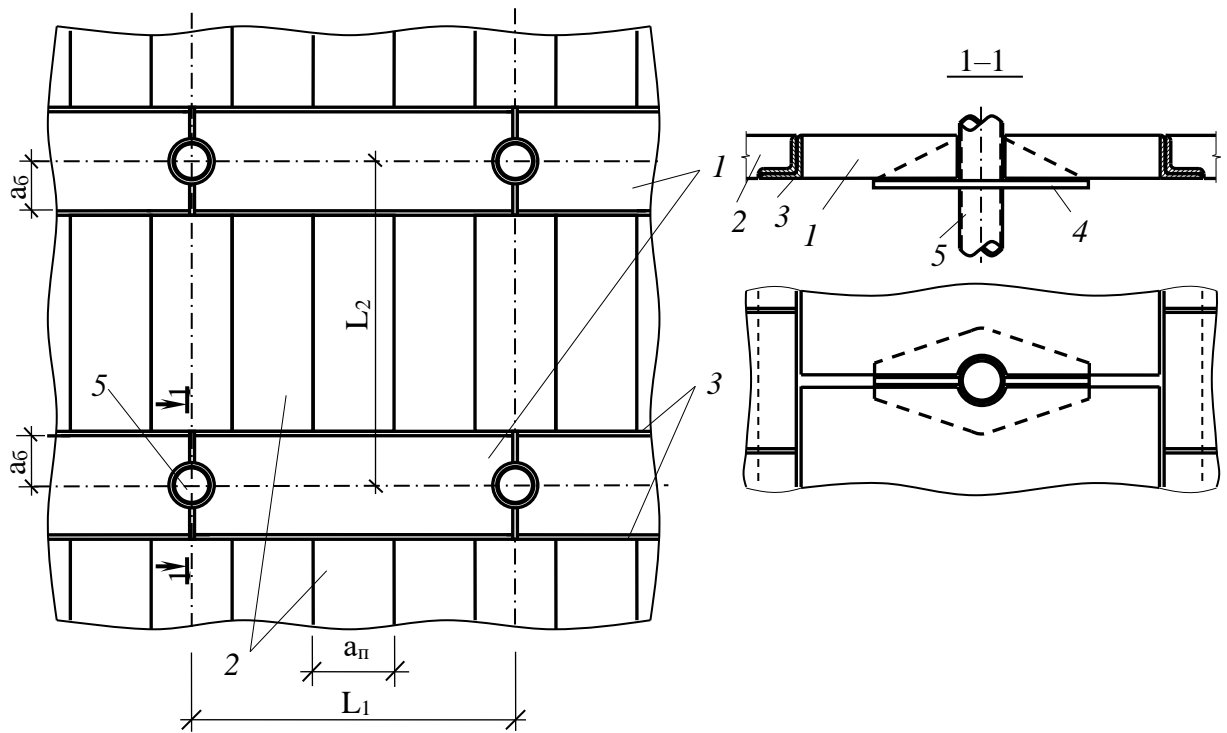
Фрагмент збірного сталезалізобетонного безбалкового перекриття системи В:
